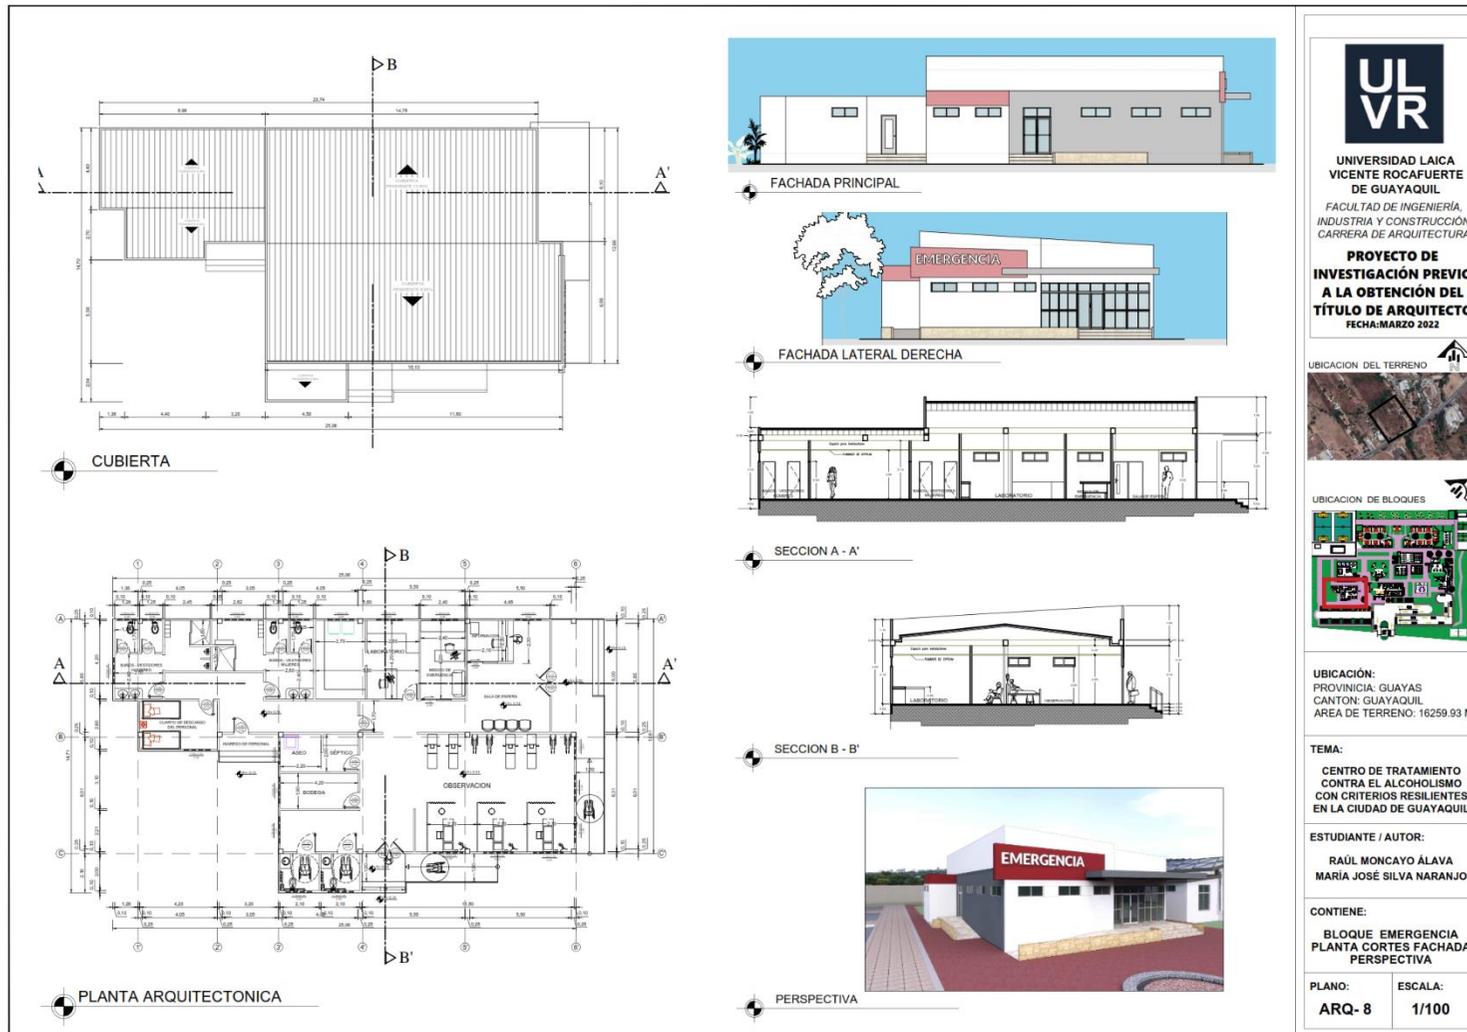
Bloque de Emergencia. Planta cortes fachada perspectiva.
